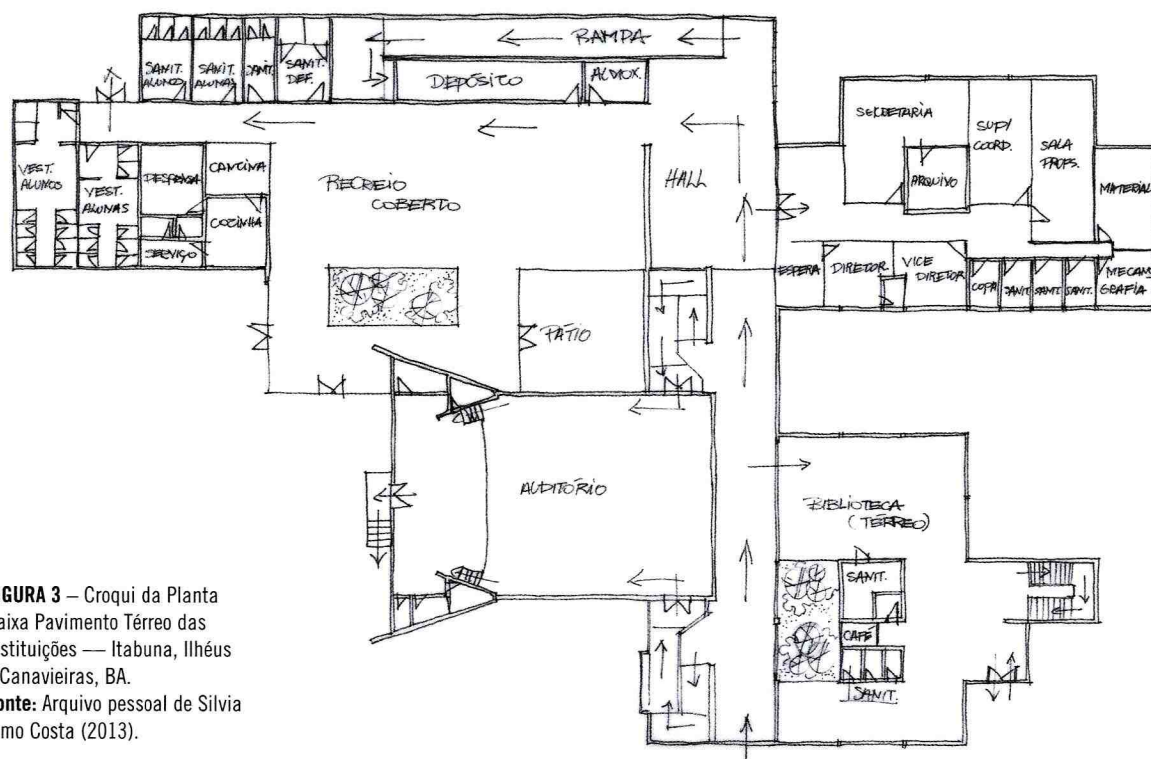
Croqui da Planta Baixa Pavimento Térreo das Instituições — Itabuna, Ilhéus e Canavieiras, BA.
